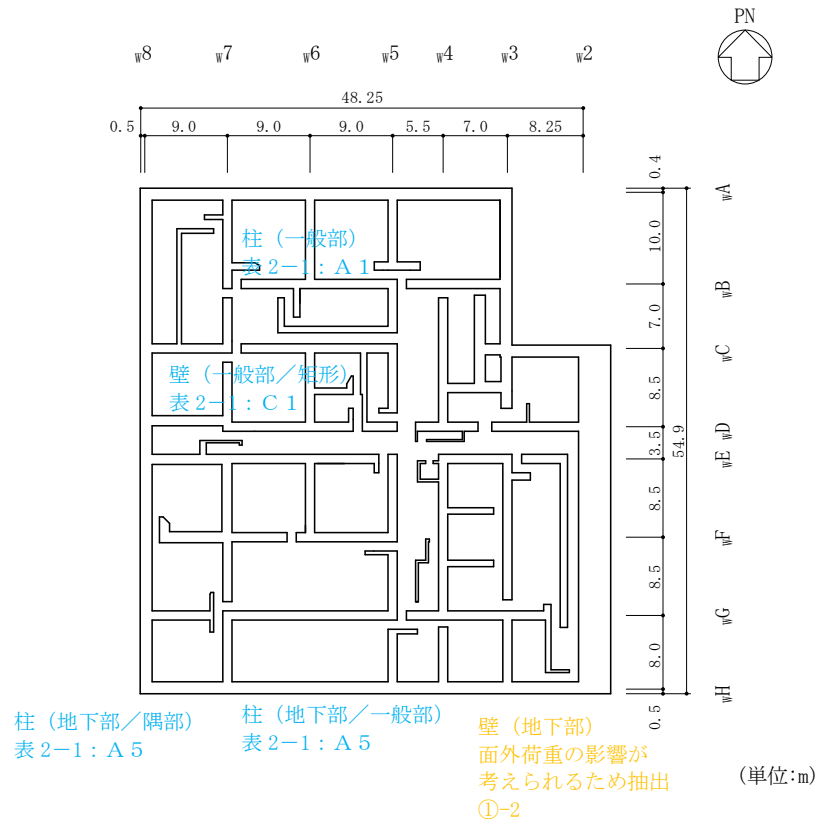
(1) 廃棄物処理建物の概略平面図 (EL 3.0m)
